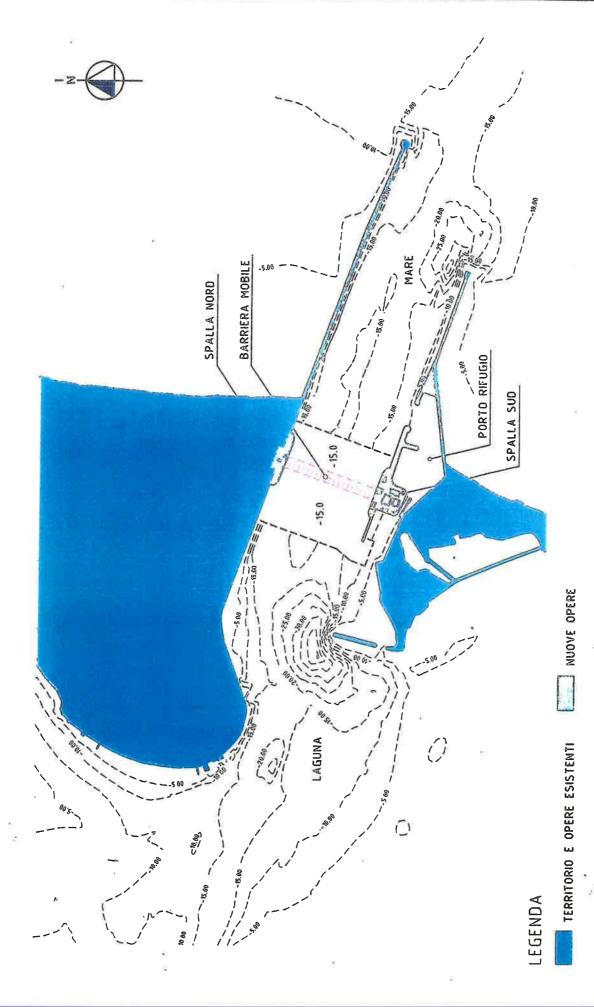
Bocca di Malamocco - Planimetria delle opere
